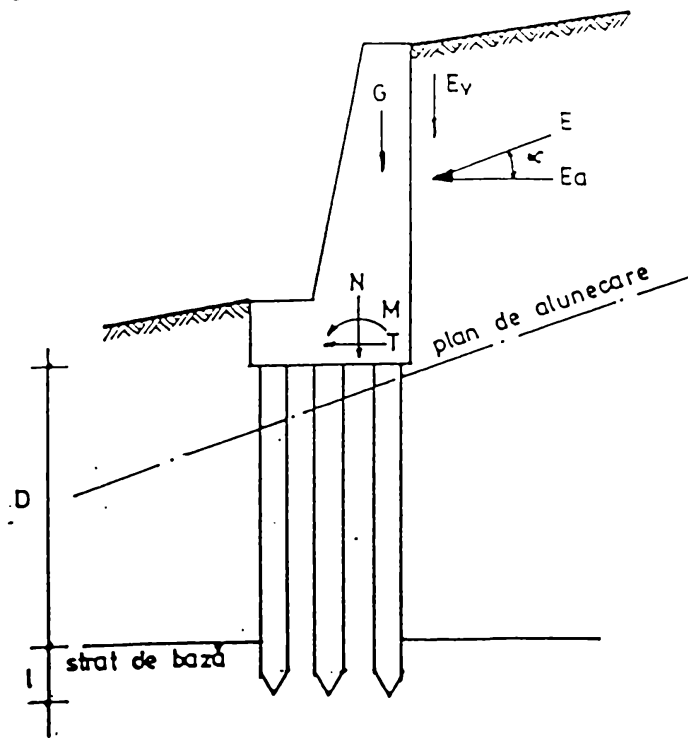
SCHEMA ZIDULUI DE SPRIJIN FONDAT PE PILOTI
